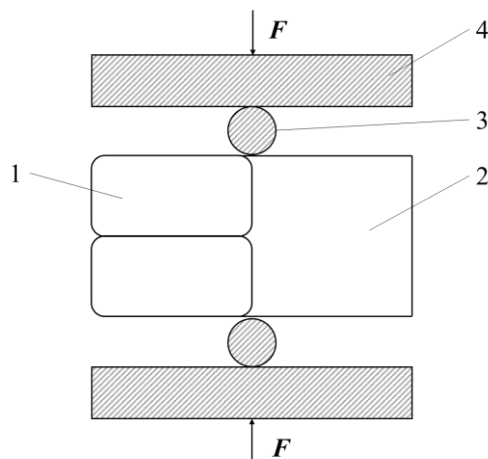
3D 打印边框与后浇混凝土界面劈裂强度测试试件制备方法
